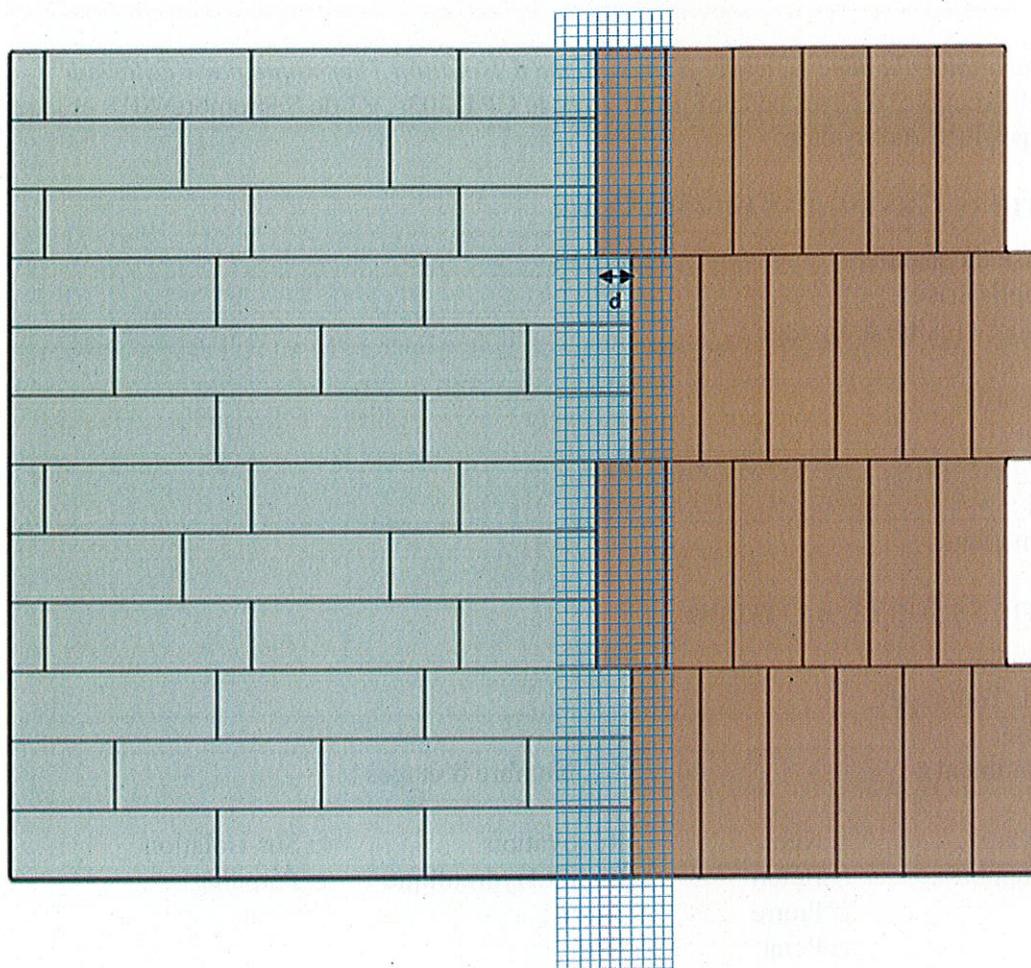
Juxtaposition des poses horizontale et verticale des panneaux isolants sur une même façade avec un recouvrement d'armature sur 10cm minimum
